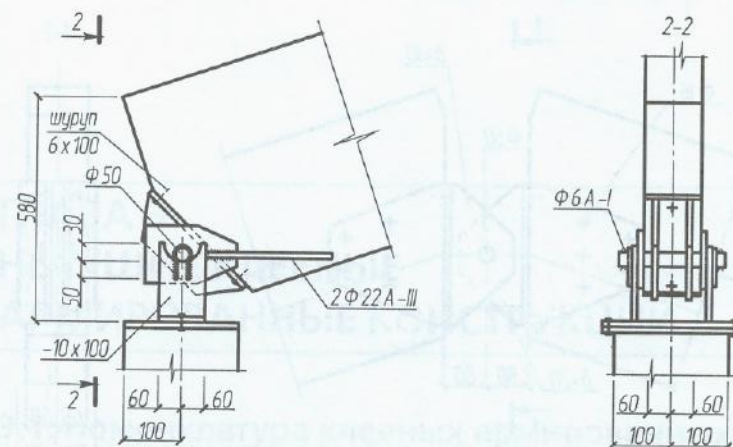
Опорный узел треугольной арки с клееным армированным верхним поясом
